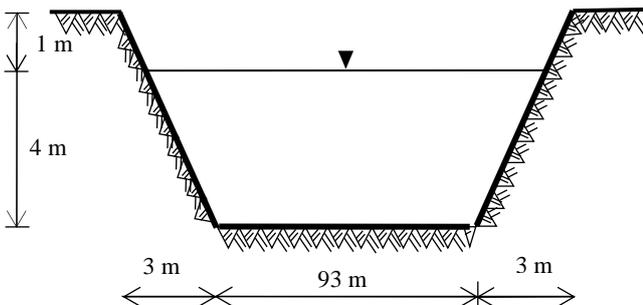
Penampang Sistem Jaringan Pipa (*Main Sump – Settling Pond*)
